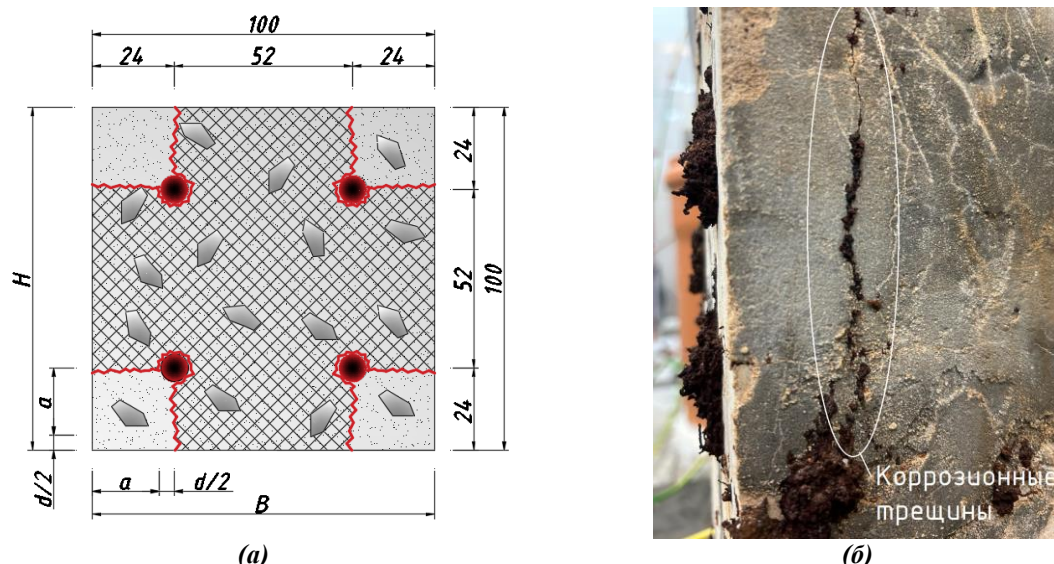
Расчетное сечение колонны с повреждением арматуры:
